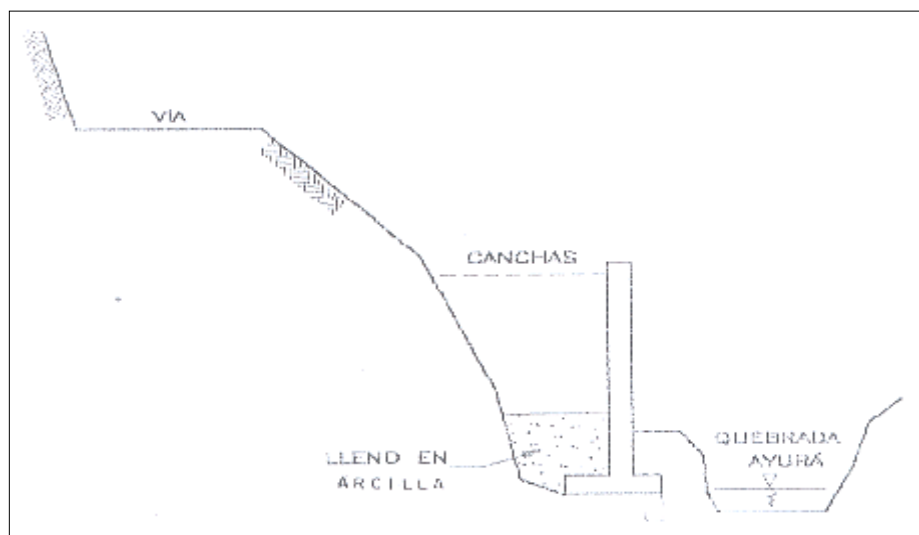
Ubicación Muro. Sección transversal (sin escala)
